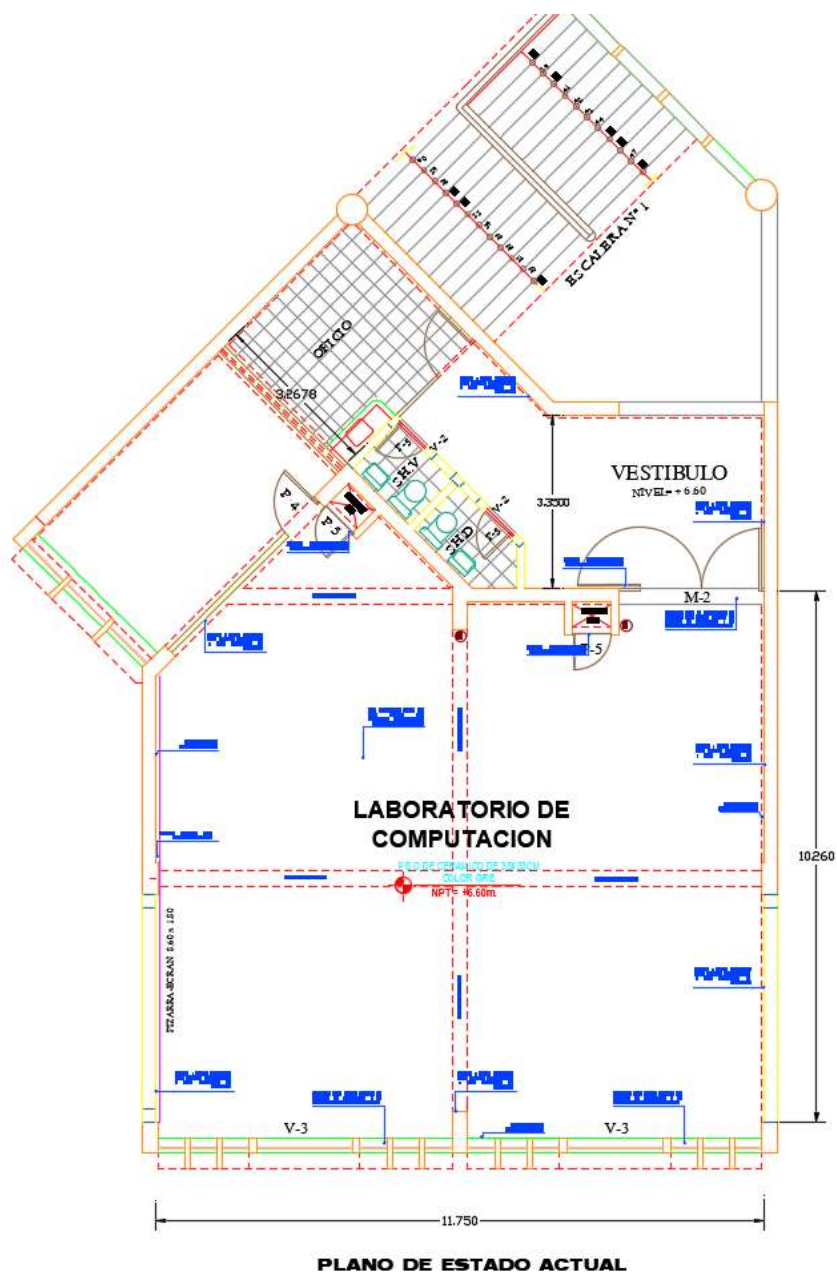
PLANO DE ESTADO ACTUAL AMBIENTE A ACONDICIONAR / 3ER PISO
